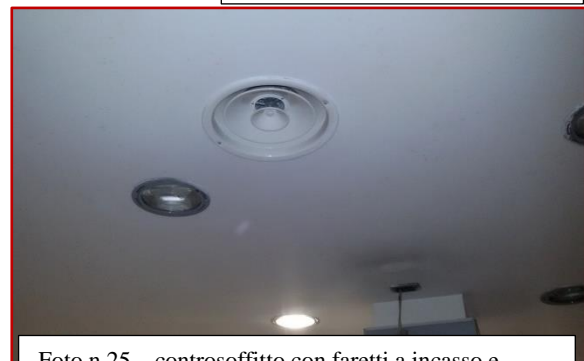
controsoffitto con faretti a incasso e impianto di areazione
